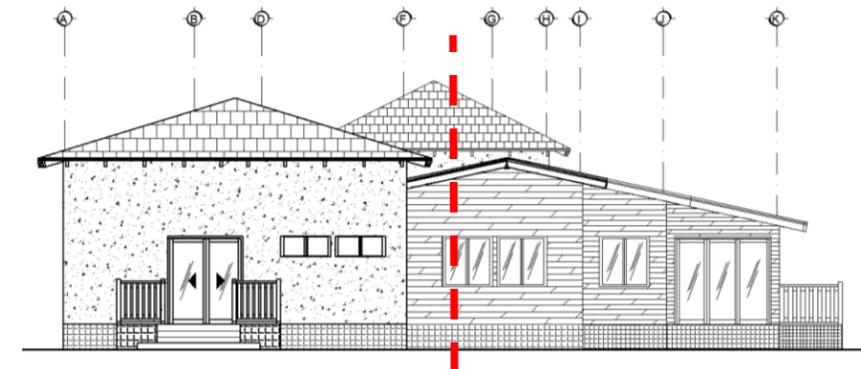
Asimetría en fachada lateral de administración. Fuente: Elaborado por autores
